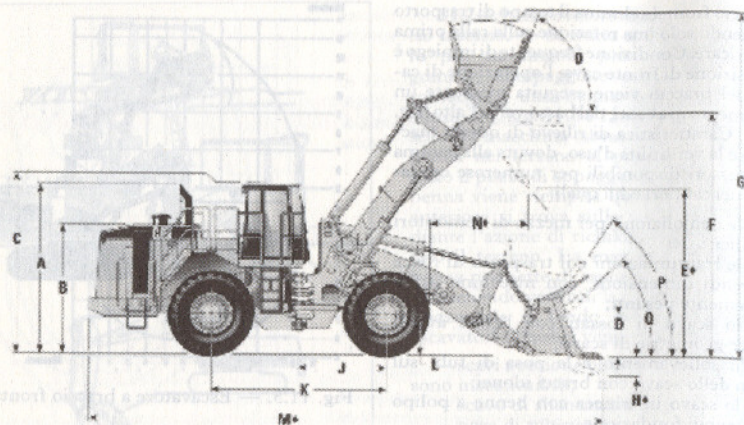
Caratteristiche dimensionali di una pala caricatrice di medie dimensioni.
